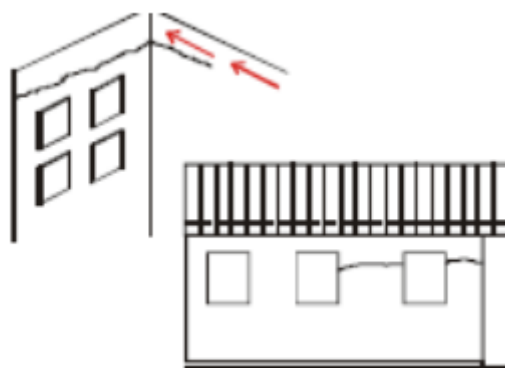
Fissuração típica nos cantos das aberturas
